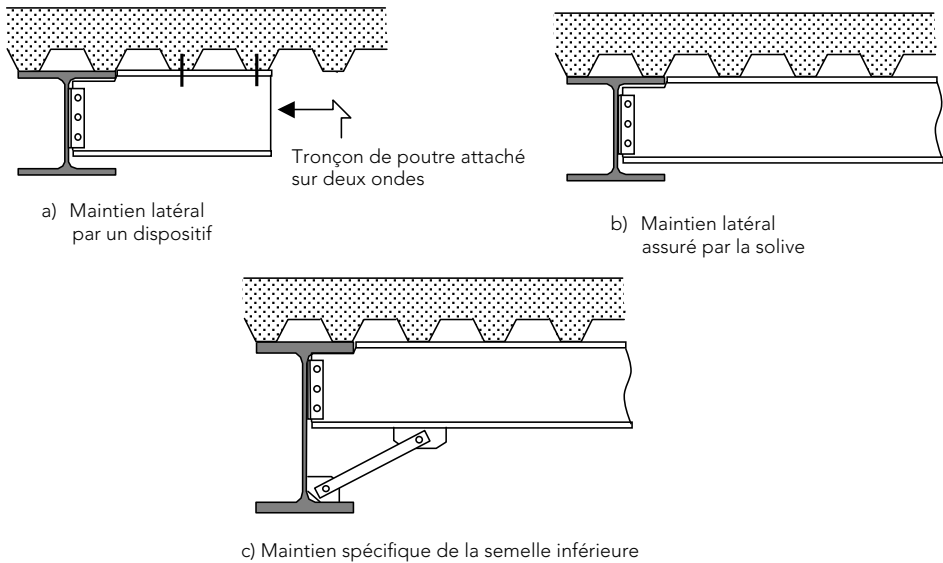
Maintiens anti-déversement d'une poutre.
